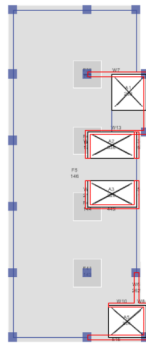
33 Denah Lantai 1 Permodelan Struktur
